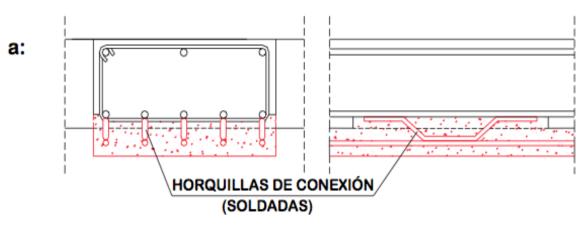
Armados para refuerzo de vigas caso a. (Fuente: Patología, reparación y refuerzo de estructuras de hormigón armado de edificación)
